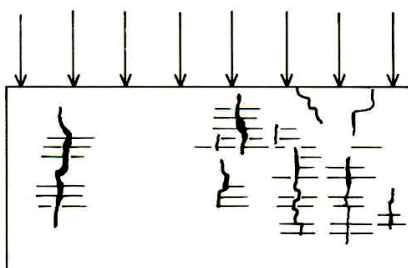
fissuração típica da alvenaria causada por sobrecarga vertical (THOMAZ, 1989, p. 64)
